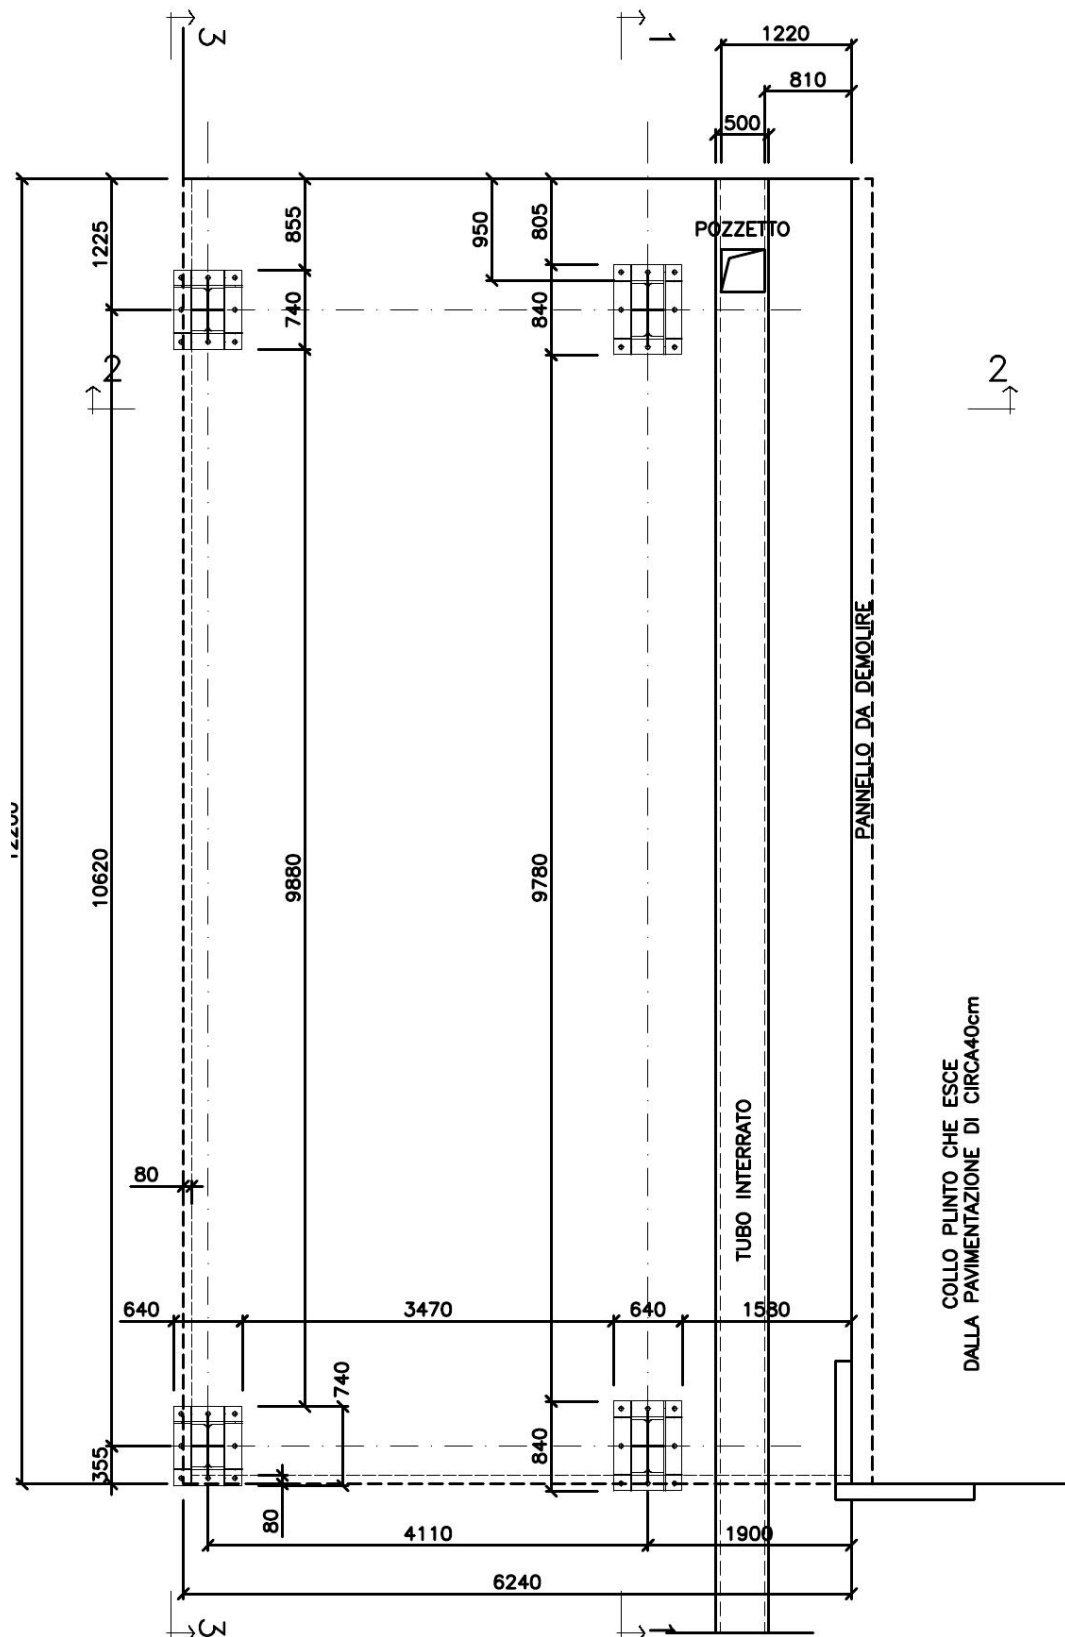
Particolare di A.2009.a.us.T02 - Progetto della struttura metallica - Pianta piano terra
